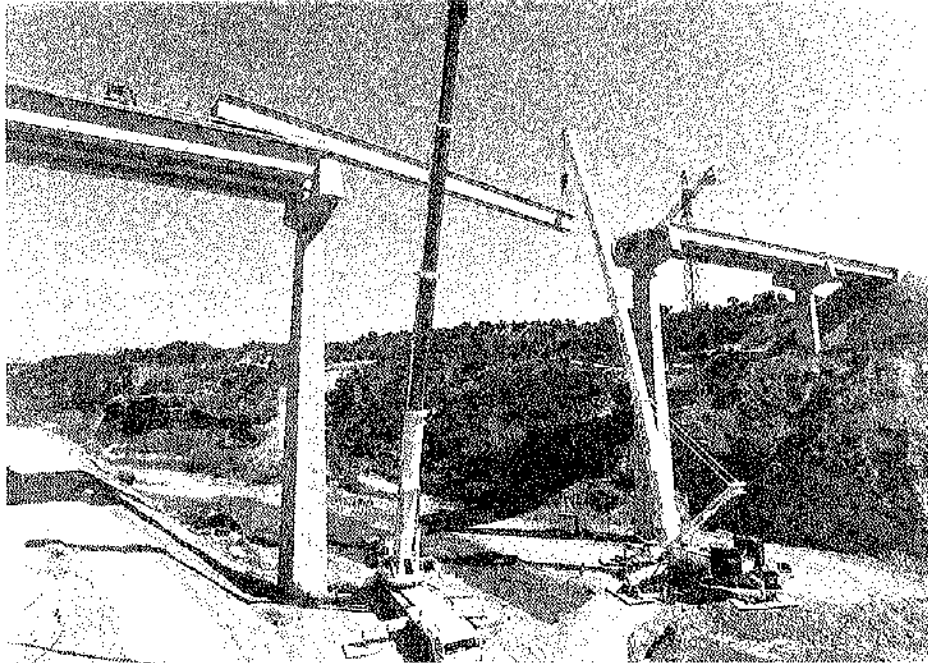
Puente sobre el río Alcanadre (Huesca). Vigas-artesa de 51 m de longitud. Montaje a 50 m de altura con autogrúas de 800 t y 400 t de capacidad.
